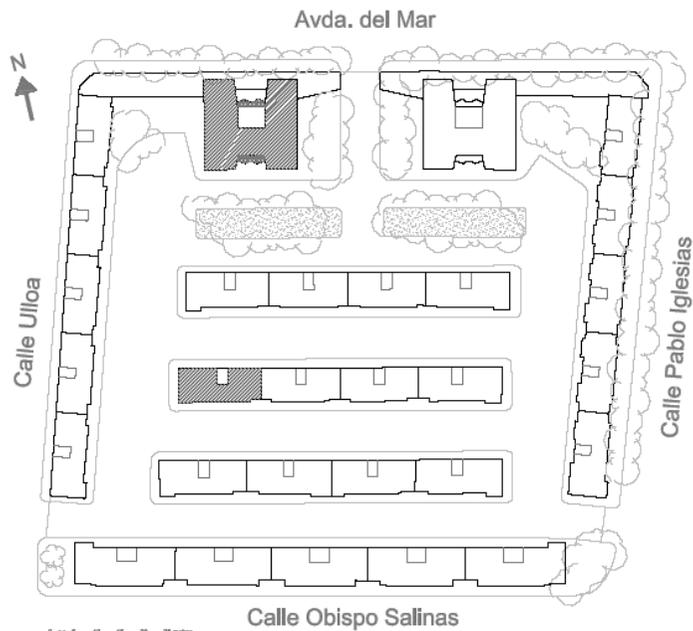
Plano de planta general del grupo 14 de Junio.
